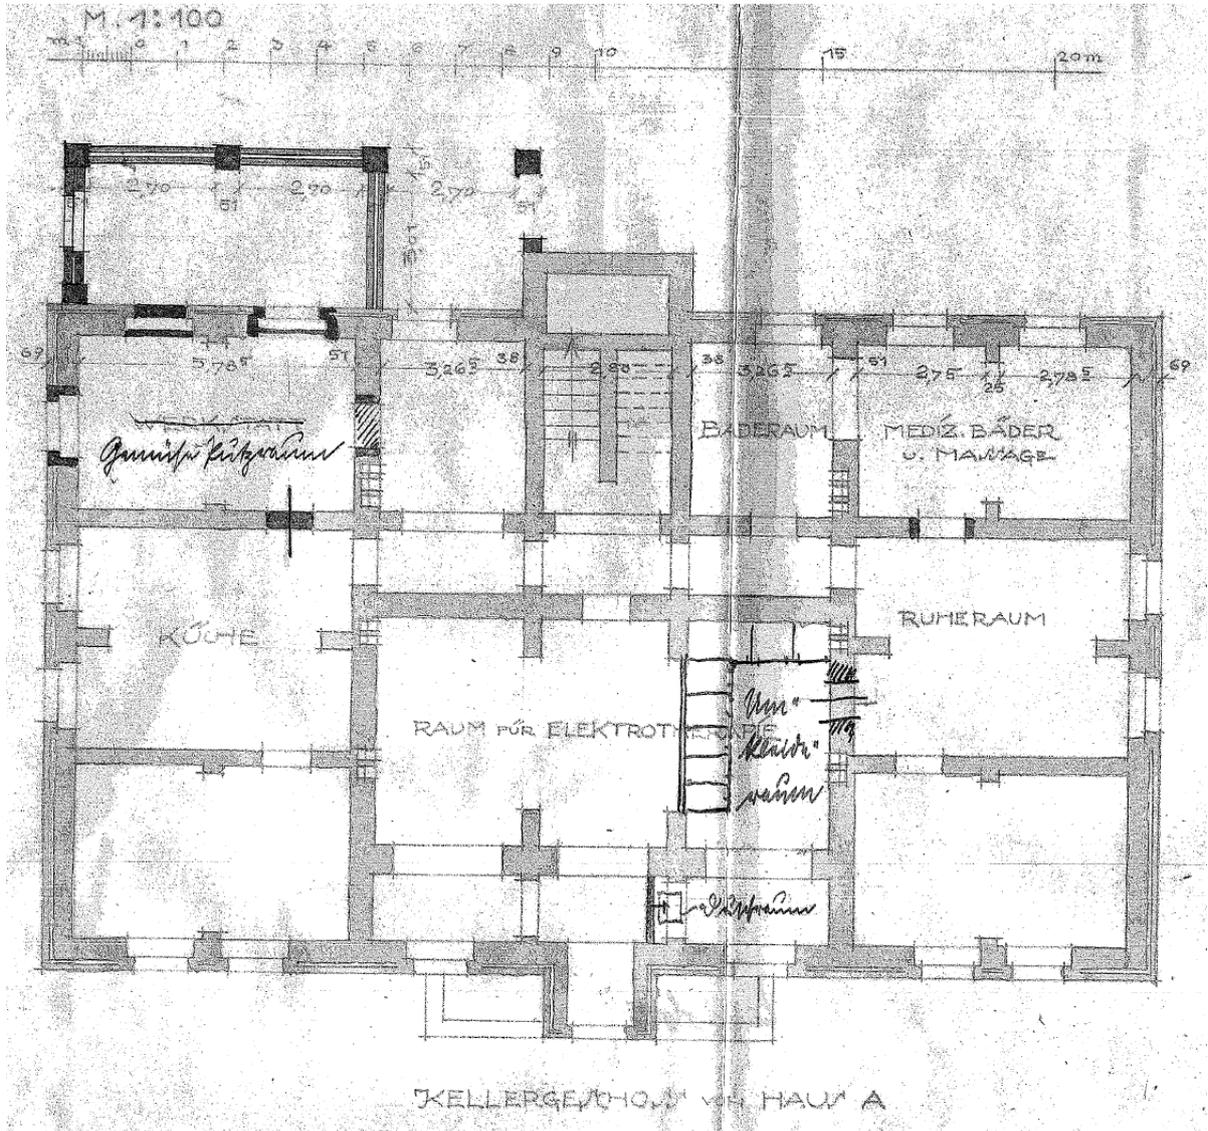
Grundriss Kellergeschoss Haus A<sup>69</sup>
